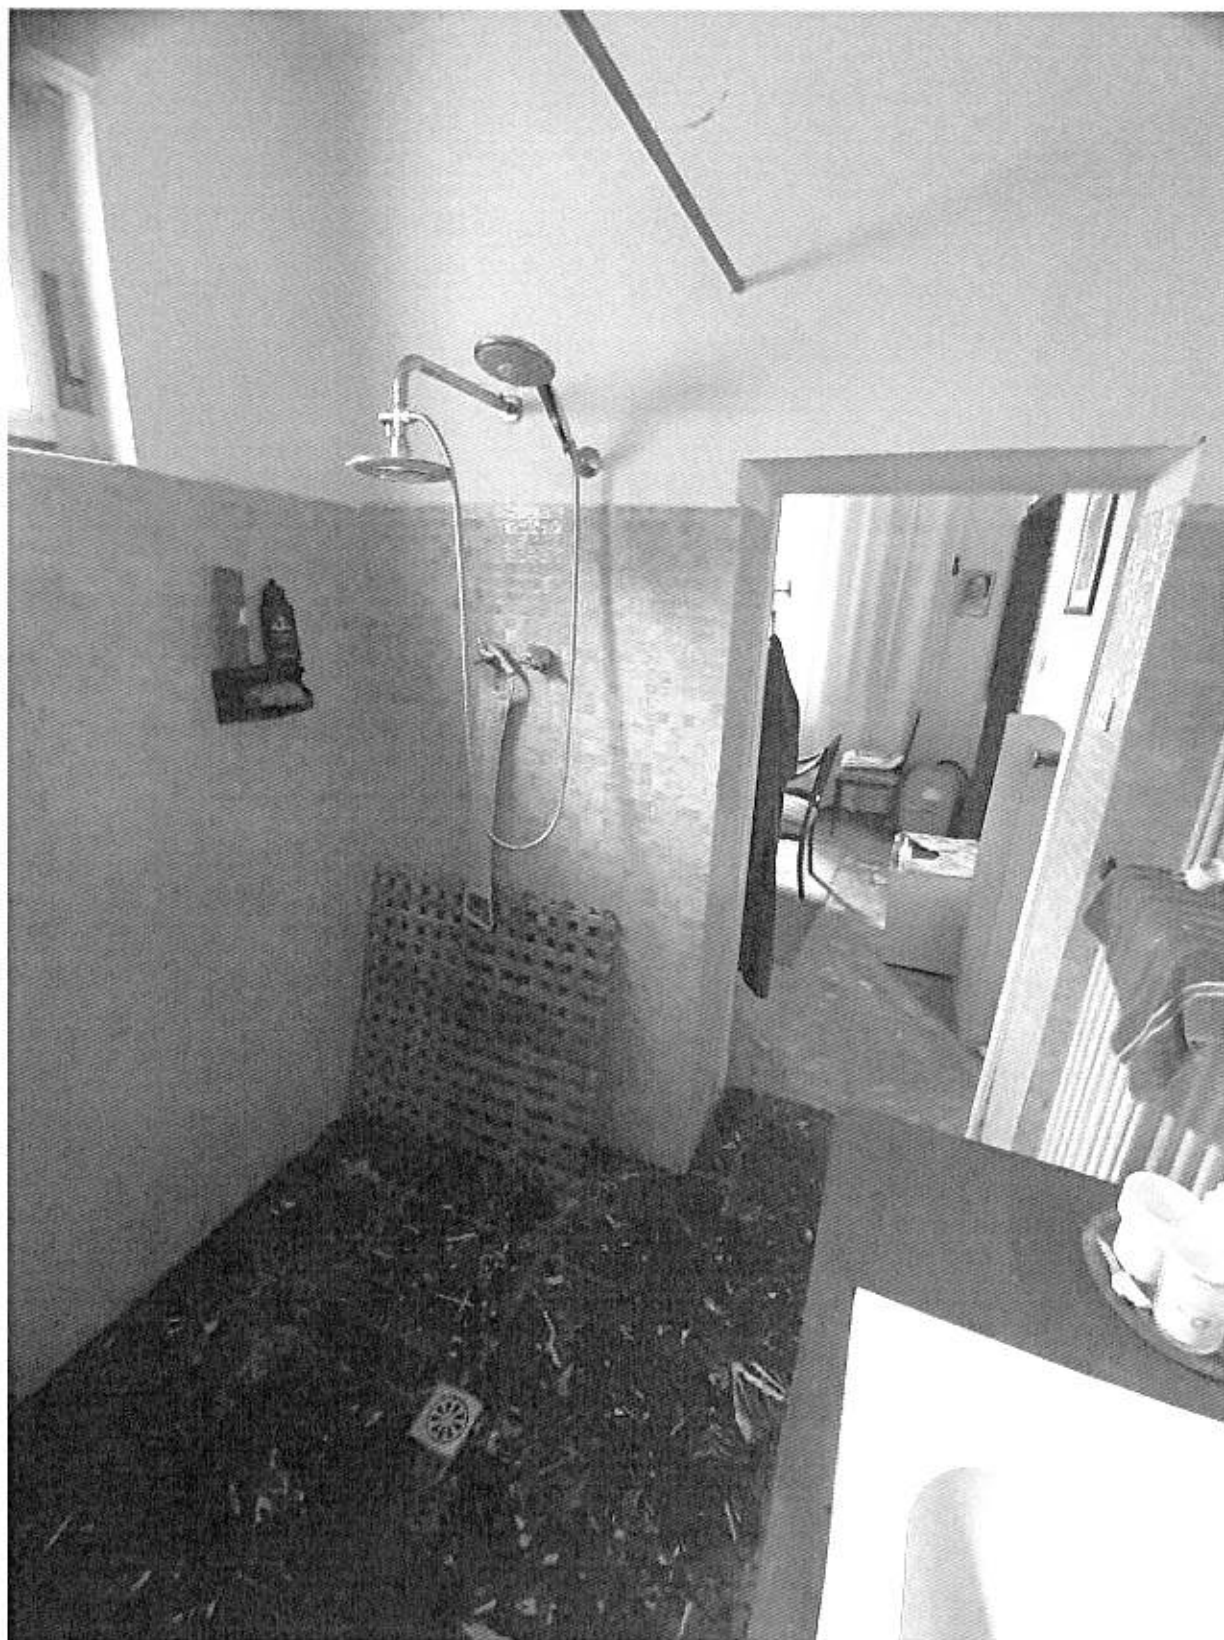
Piano Terra - W.C. e Corridoio I
